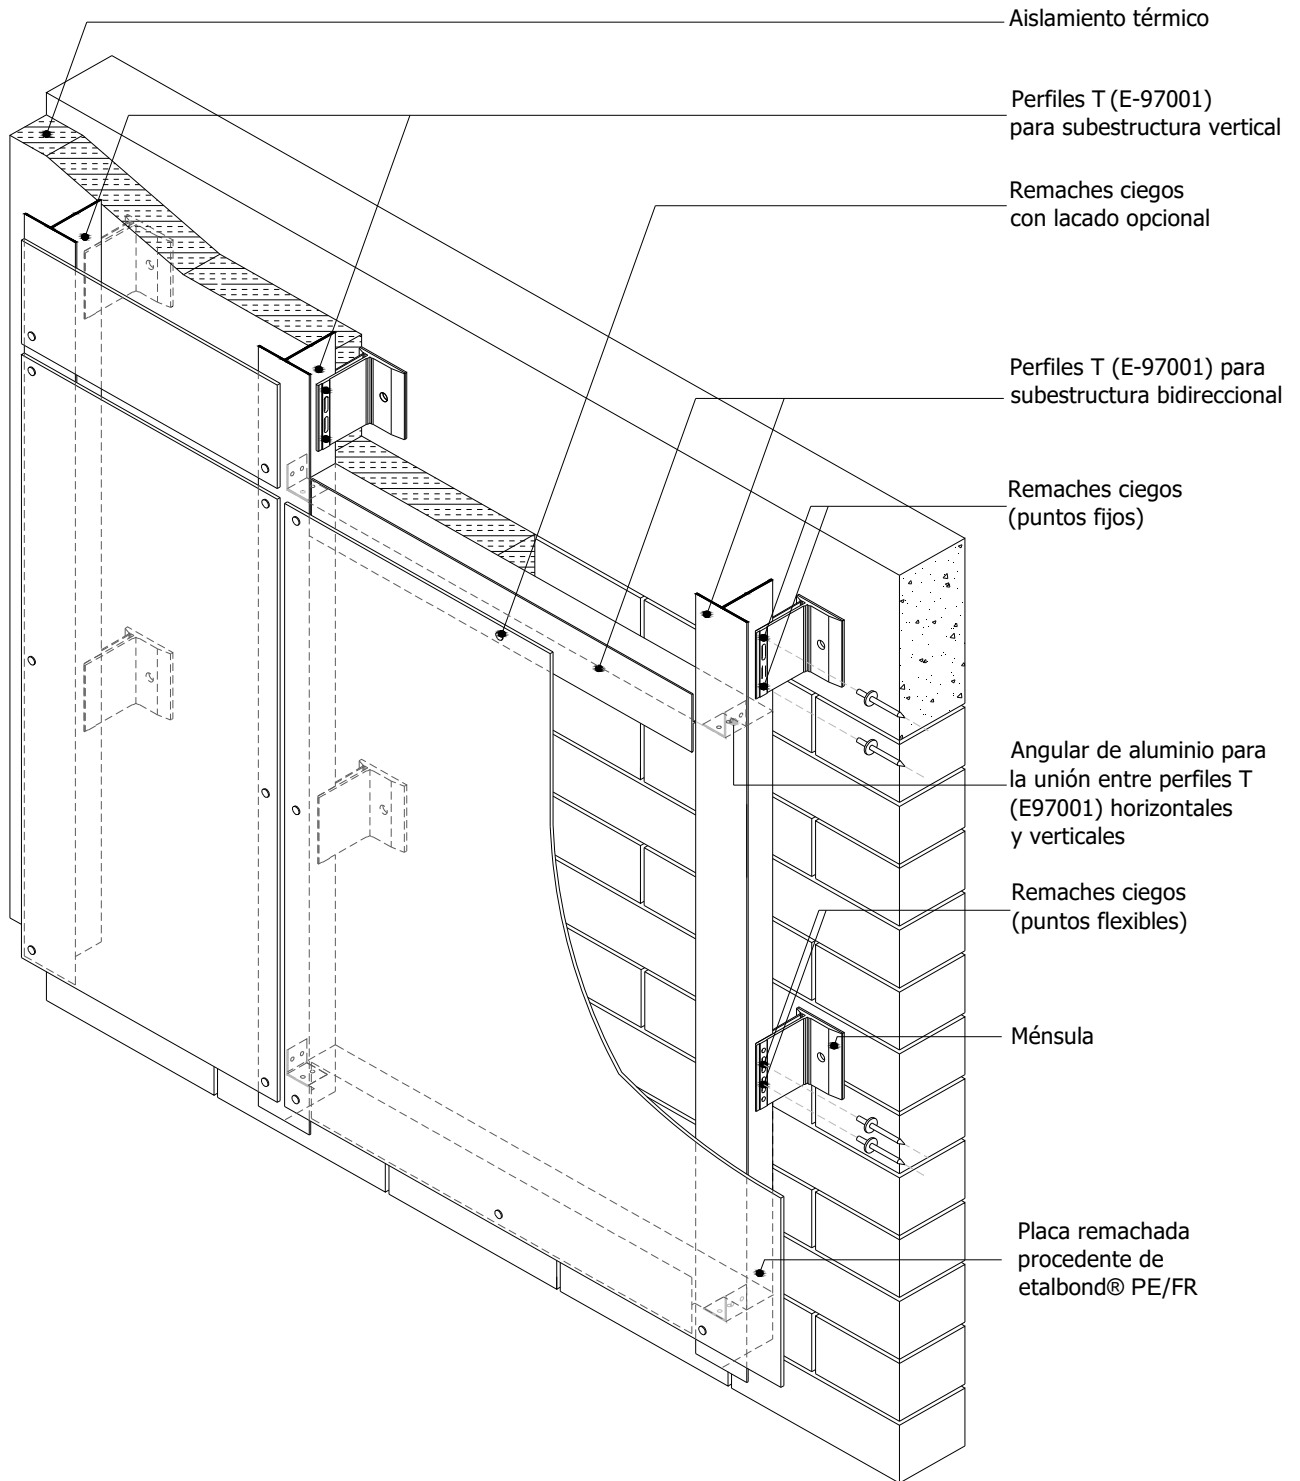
Vista general del kit etalbond® PE/FR Riveted Boards
